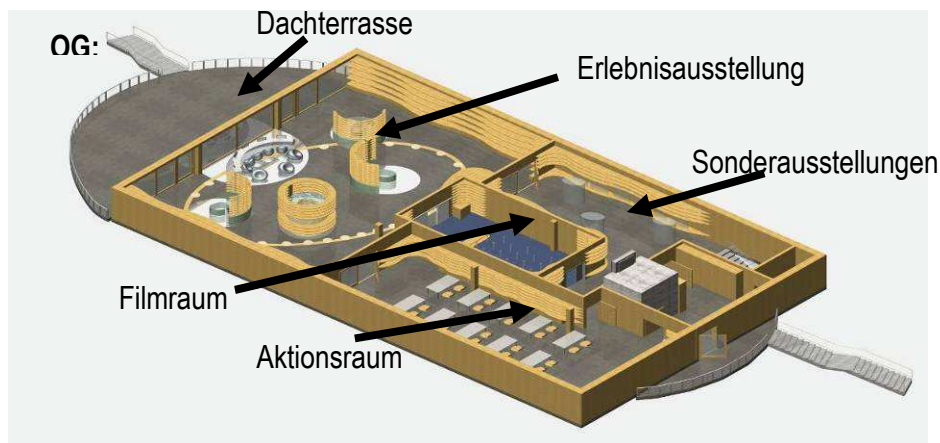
Grundrissplan Obergeschoß mit Funktionszuteilung
